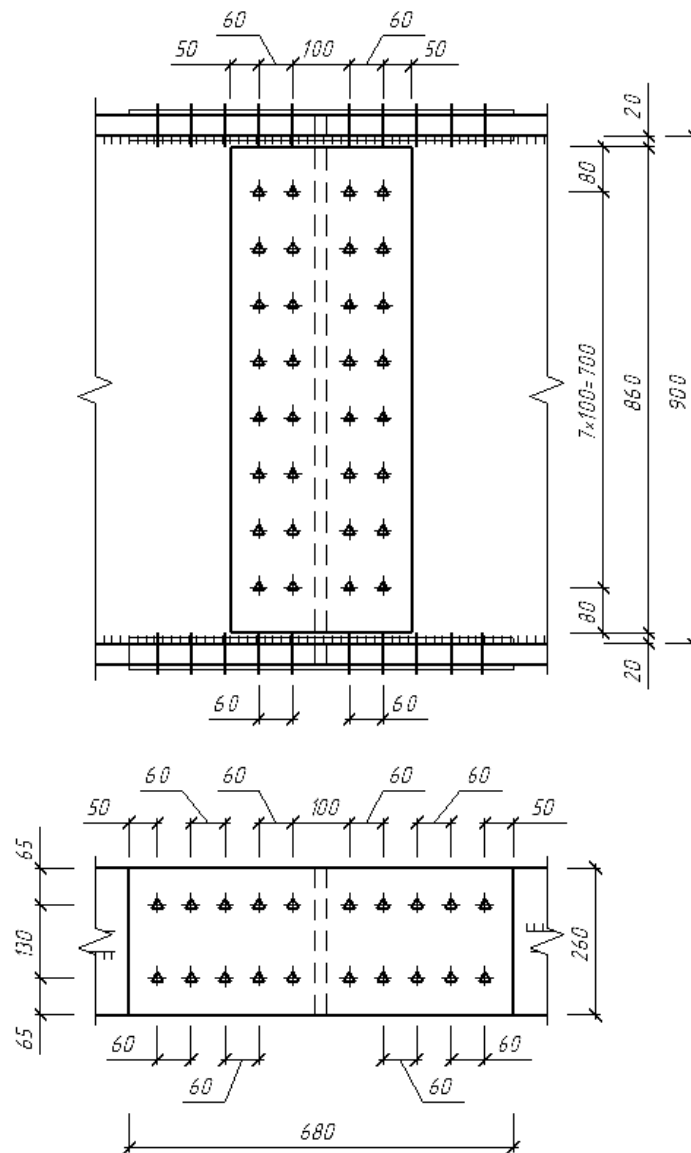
Размещение болтов на монтажном стыке главной балки
